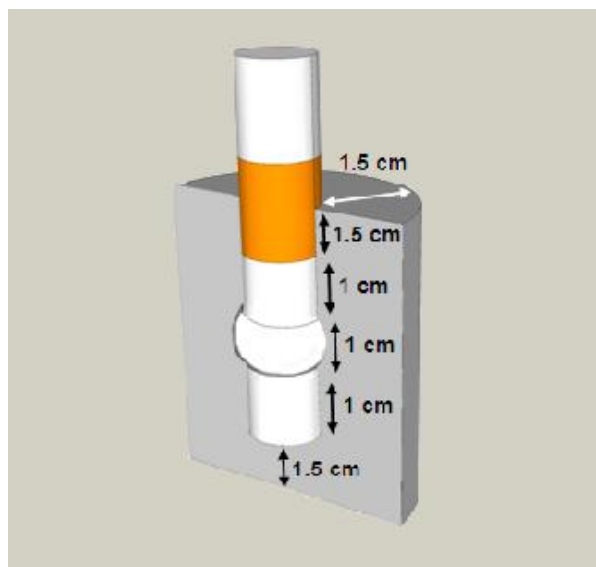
esquema de las armaduras soldadas embebidas en mortero.
